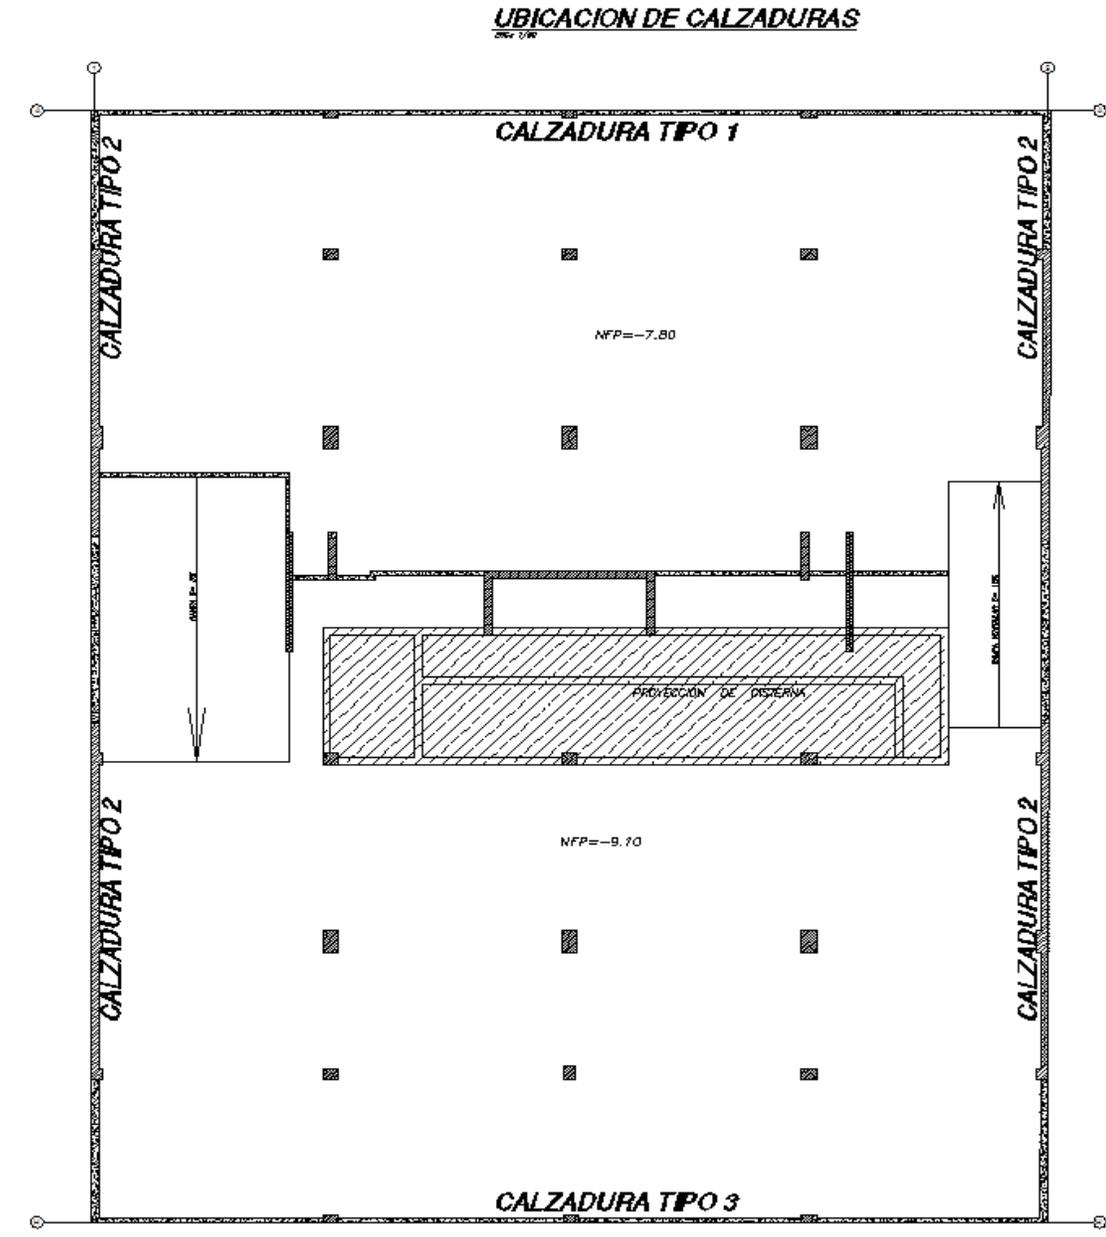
Planta de Ubicación de Calzaduras del Edificio de Oficinas Monte Rosa.
